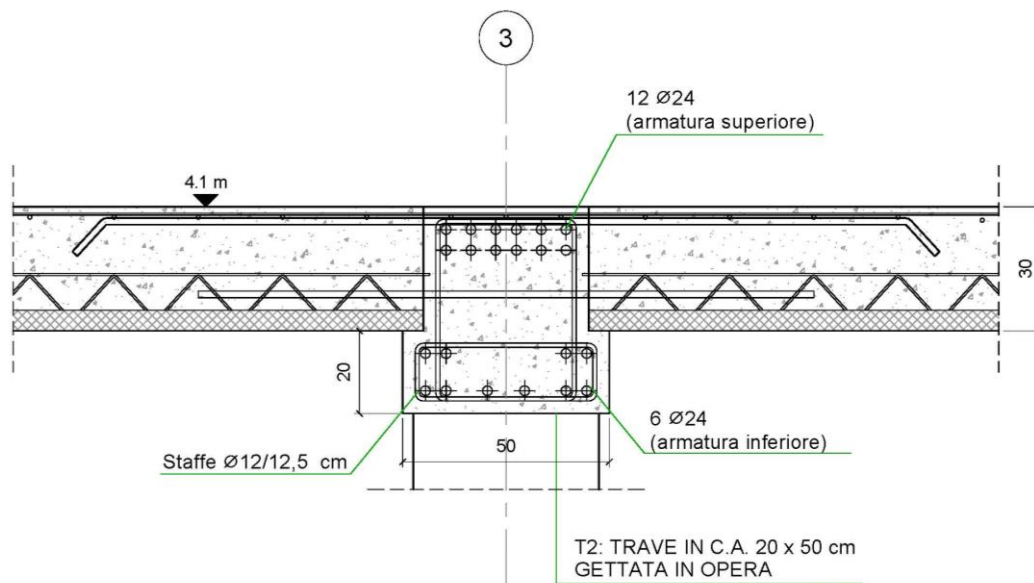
Dettaglio trave-solaio predalles in corrispondenza dell'appoggio R-3
